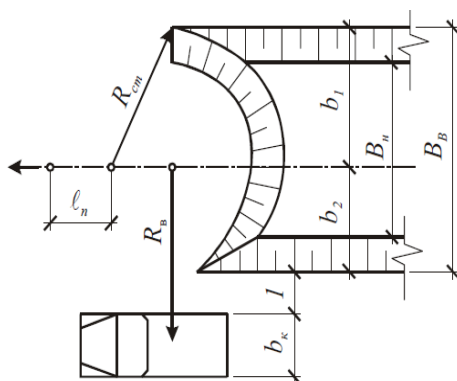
Схема разработки выемки торцевой проходки (лобовая проходка)
